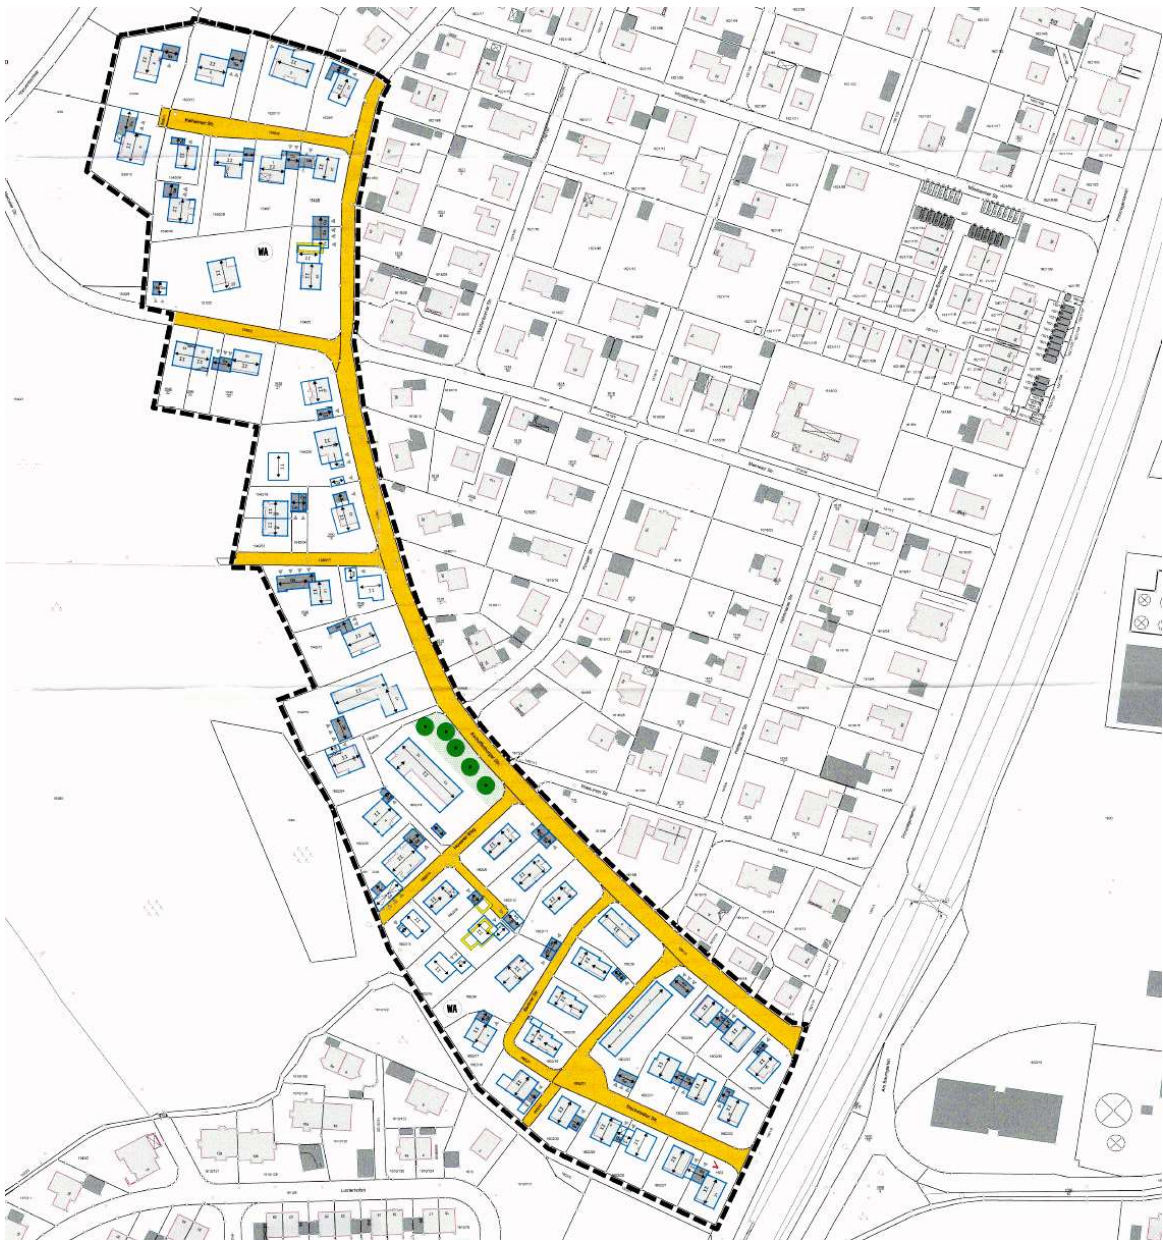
Darstellung Planzeichnung 13. Änderung Bebauungsplan „Redenfelden – West“ (Teil 1) – ohne Maßstab
